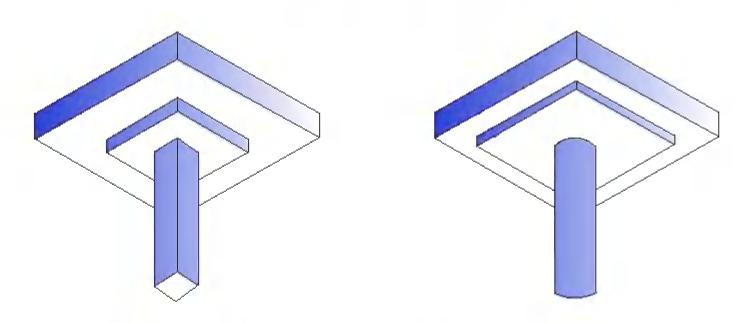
بلاطة مسطحة لوحية Flat plate
